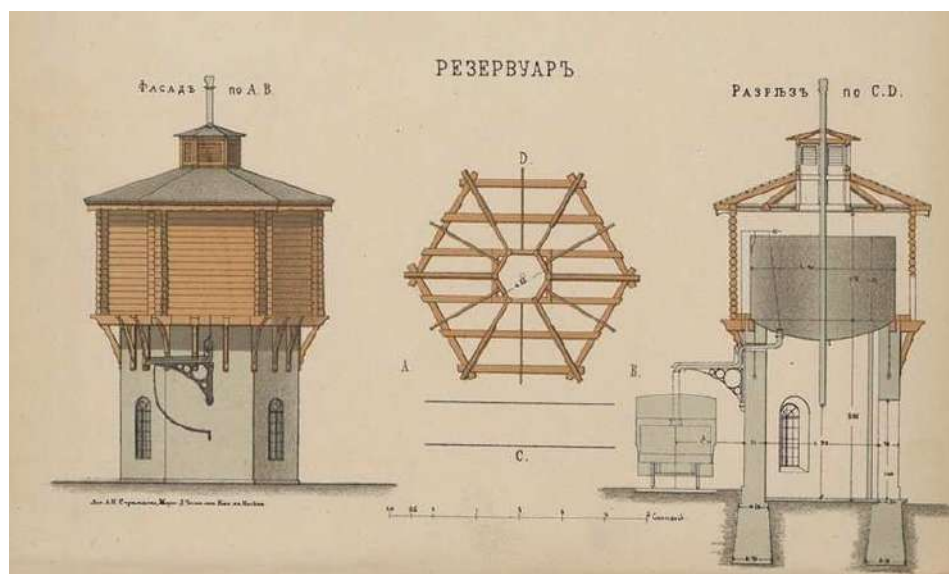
Фасад, план кровли и разрез башни. Источник: <https://vk.com/bashnyanaplotinke>
